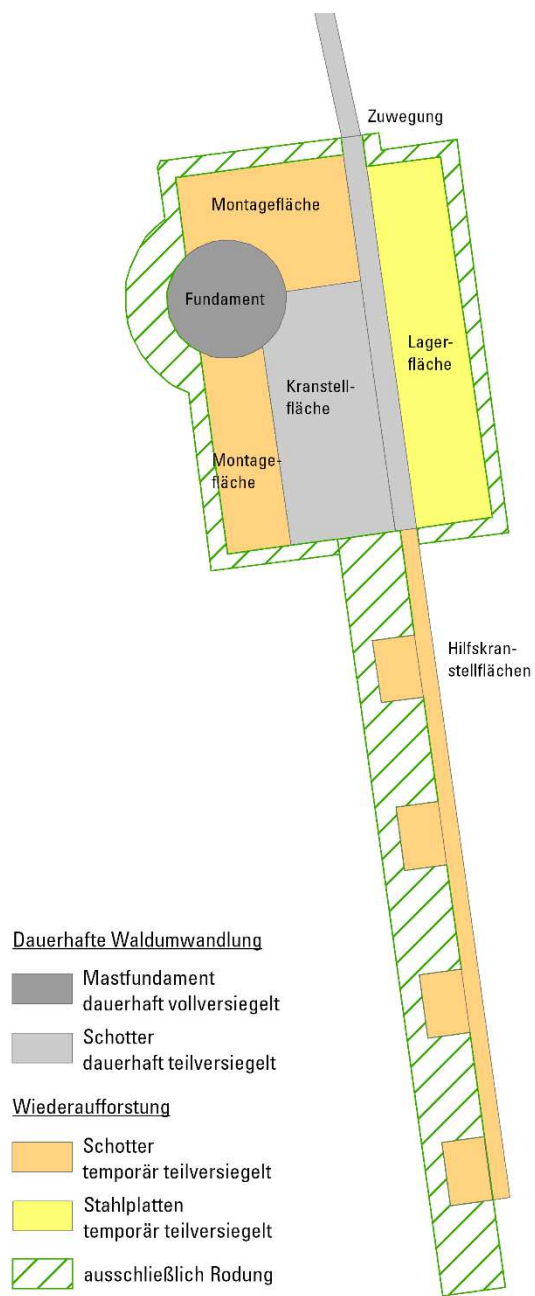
Beispielhafter Lageplan einer WEA des Typs E160 EP5 E2 im Wald mit baubedingt benötigten Flächen.
